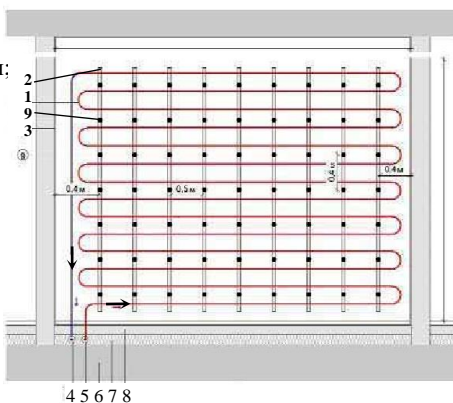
Схематичное изображение системы настенного отопления REHAU с укладкой труб змеевиком при «мокром» способе монтажа (www.REHAU.ru)
